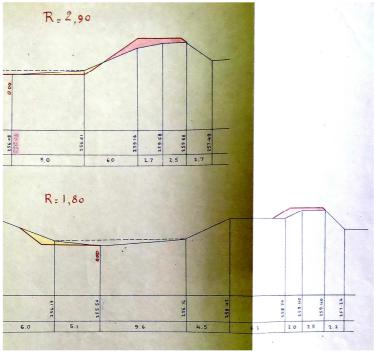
Deux profils en travers illustrant le curage et renforcement des digues (avec et sans risberme), 1948 (Ponts & Chaussées, P&C2)
